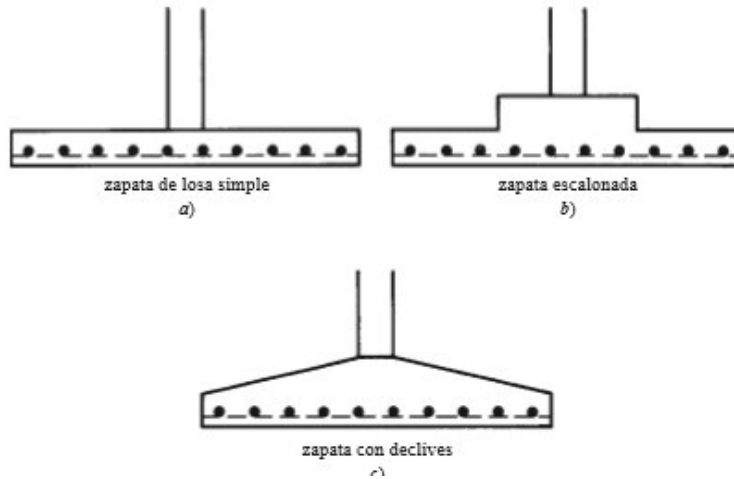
Zapatas Aisladas cuadradas o rectangulares
